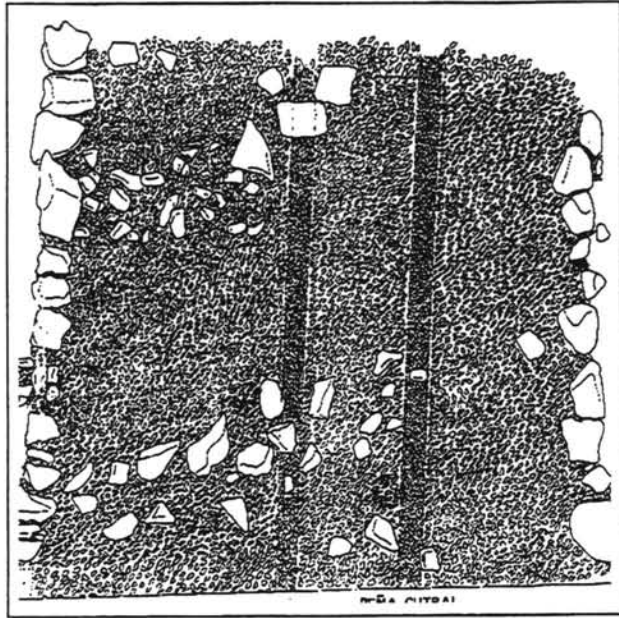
Planimetría de la vía descubierta en el Sondeo 9.
